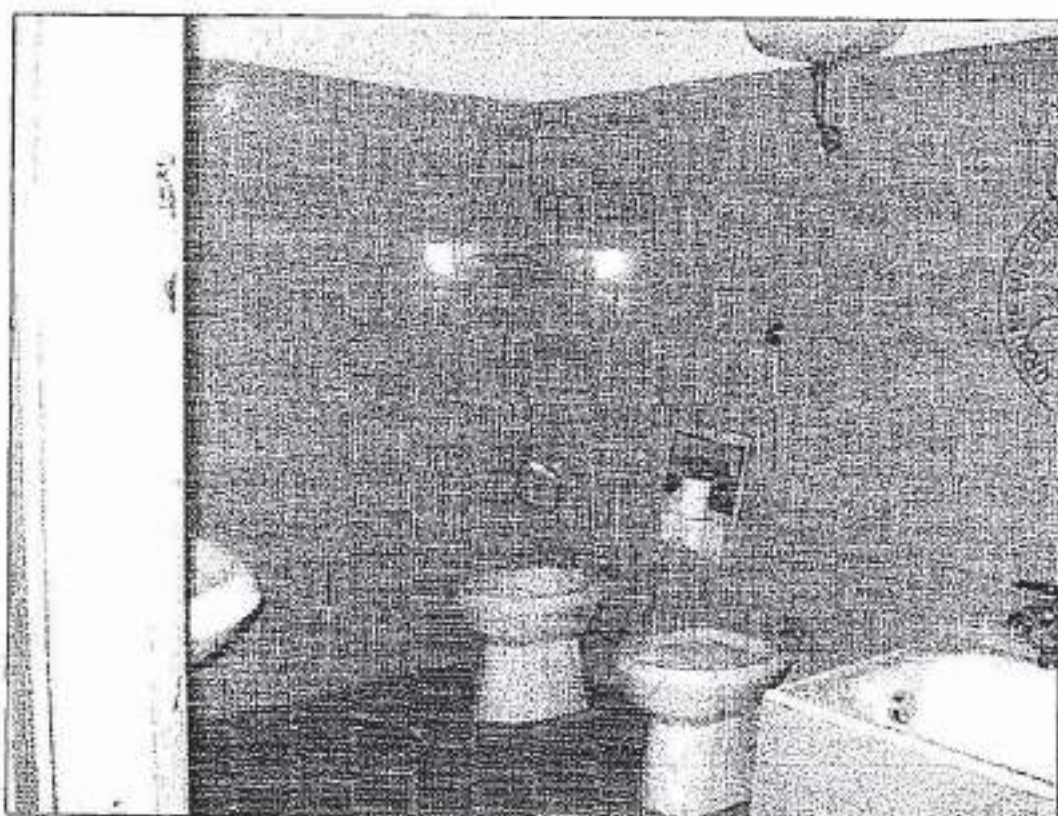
Vista interna del lotto n. 8. Magazzini al piano terra prospicienti via del Turismo.
